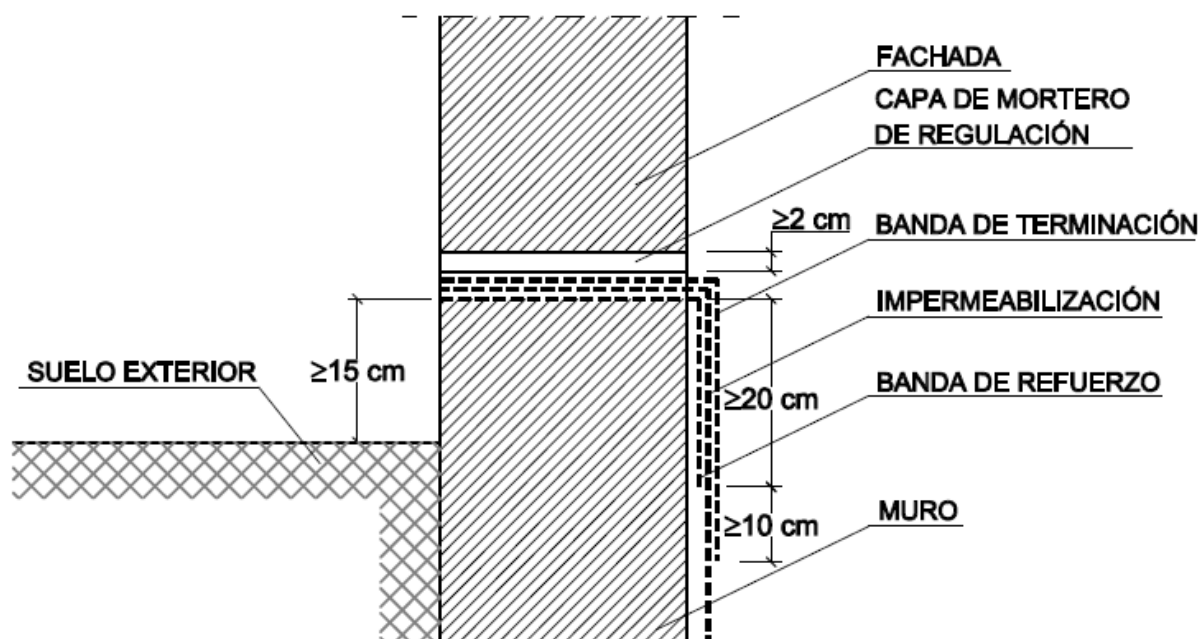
Ejemplo de encuentro de un muro impermeabilizado por el interior con lámina con una fachada
